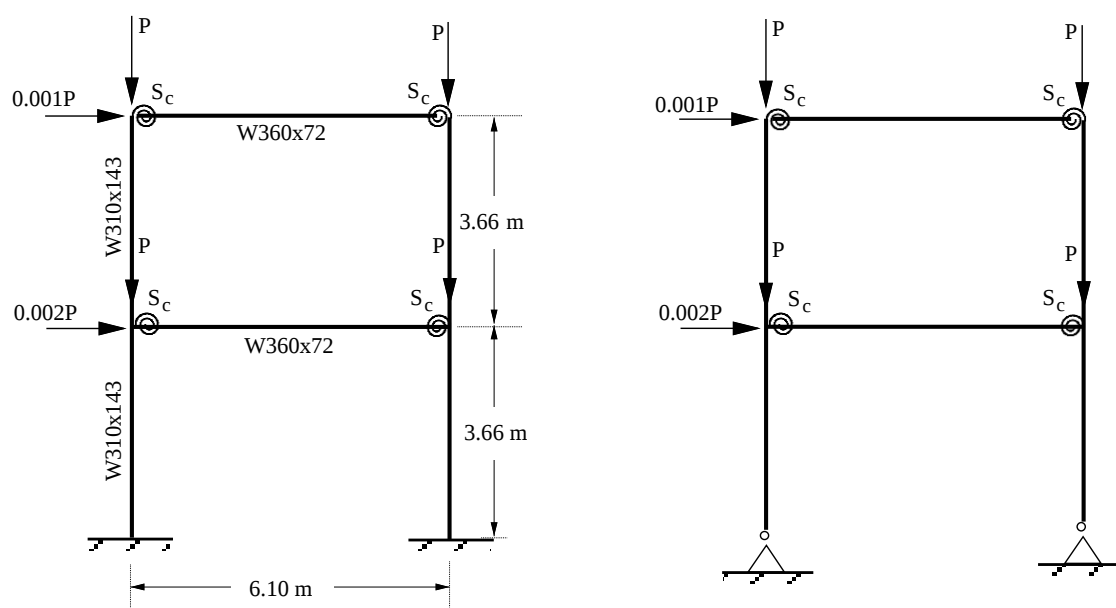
Sistemas estruturais analisados: geometria e carregamento
